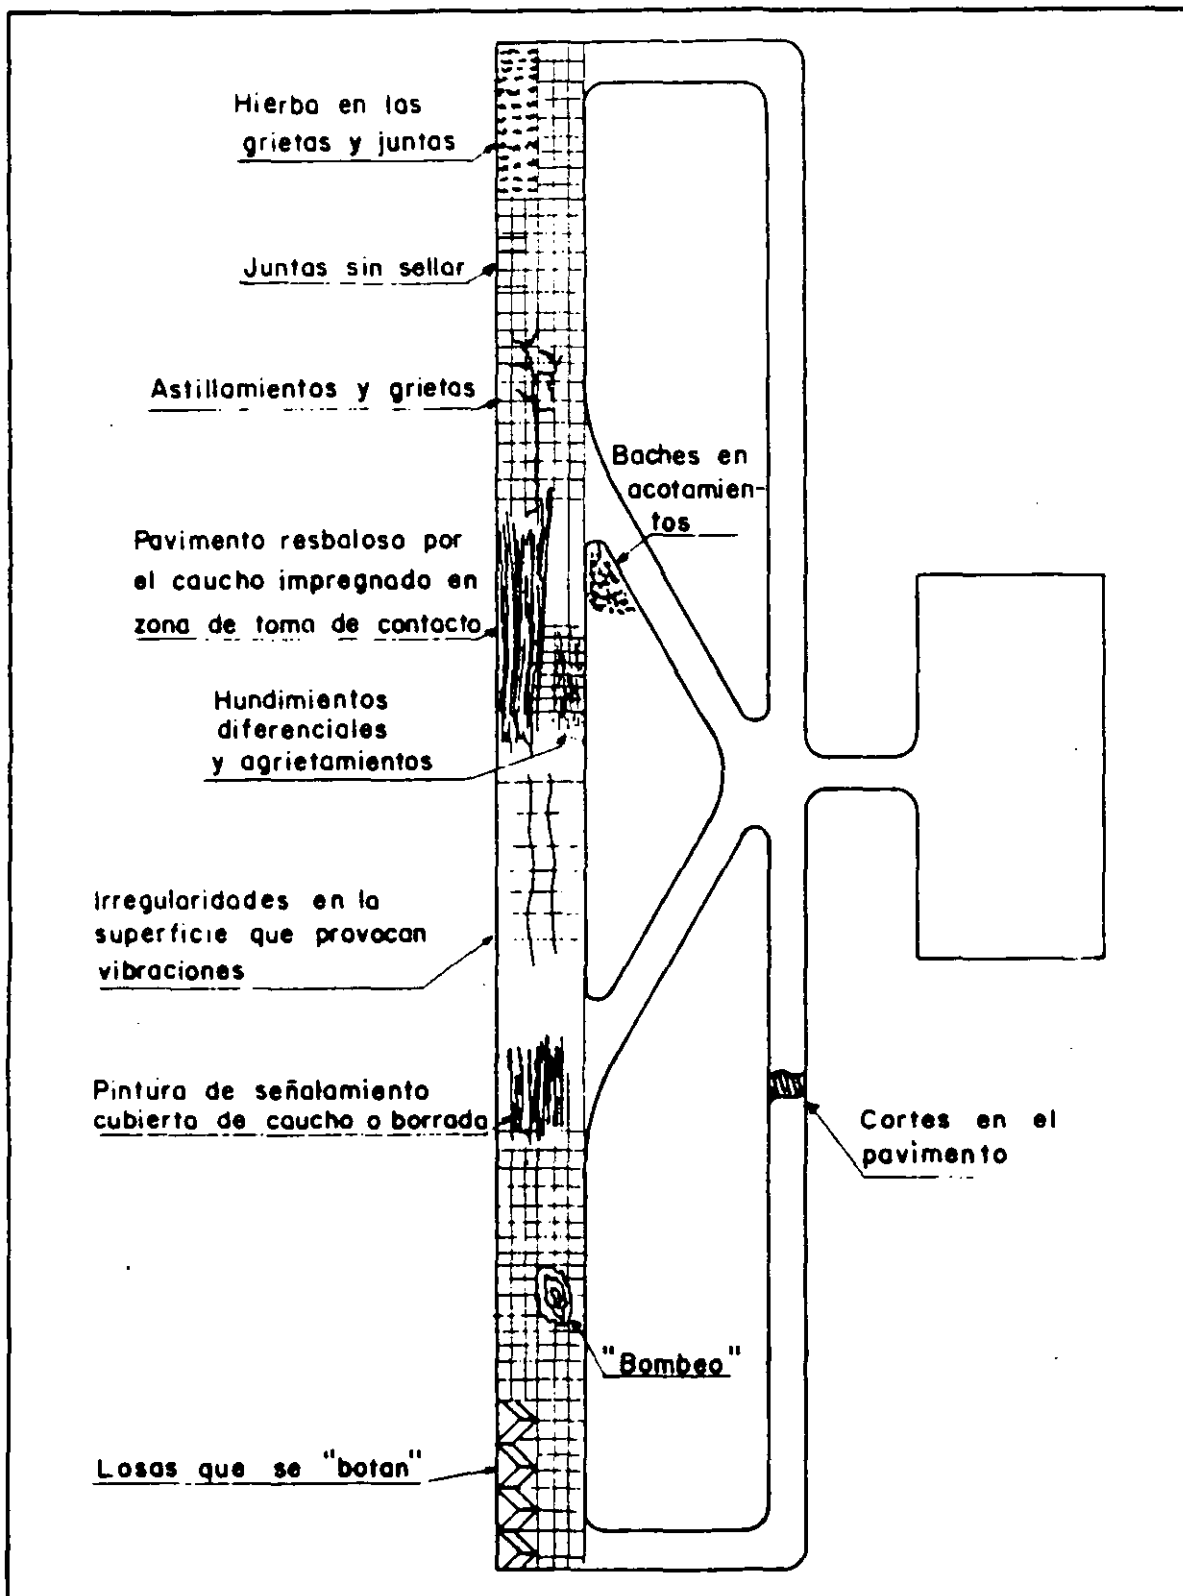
Detalles a observar en pavimentos rígidos
